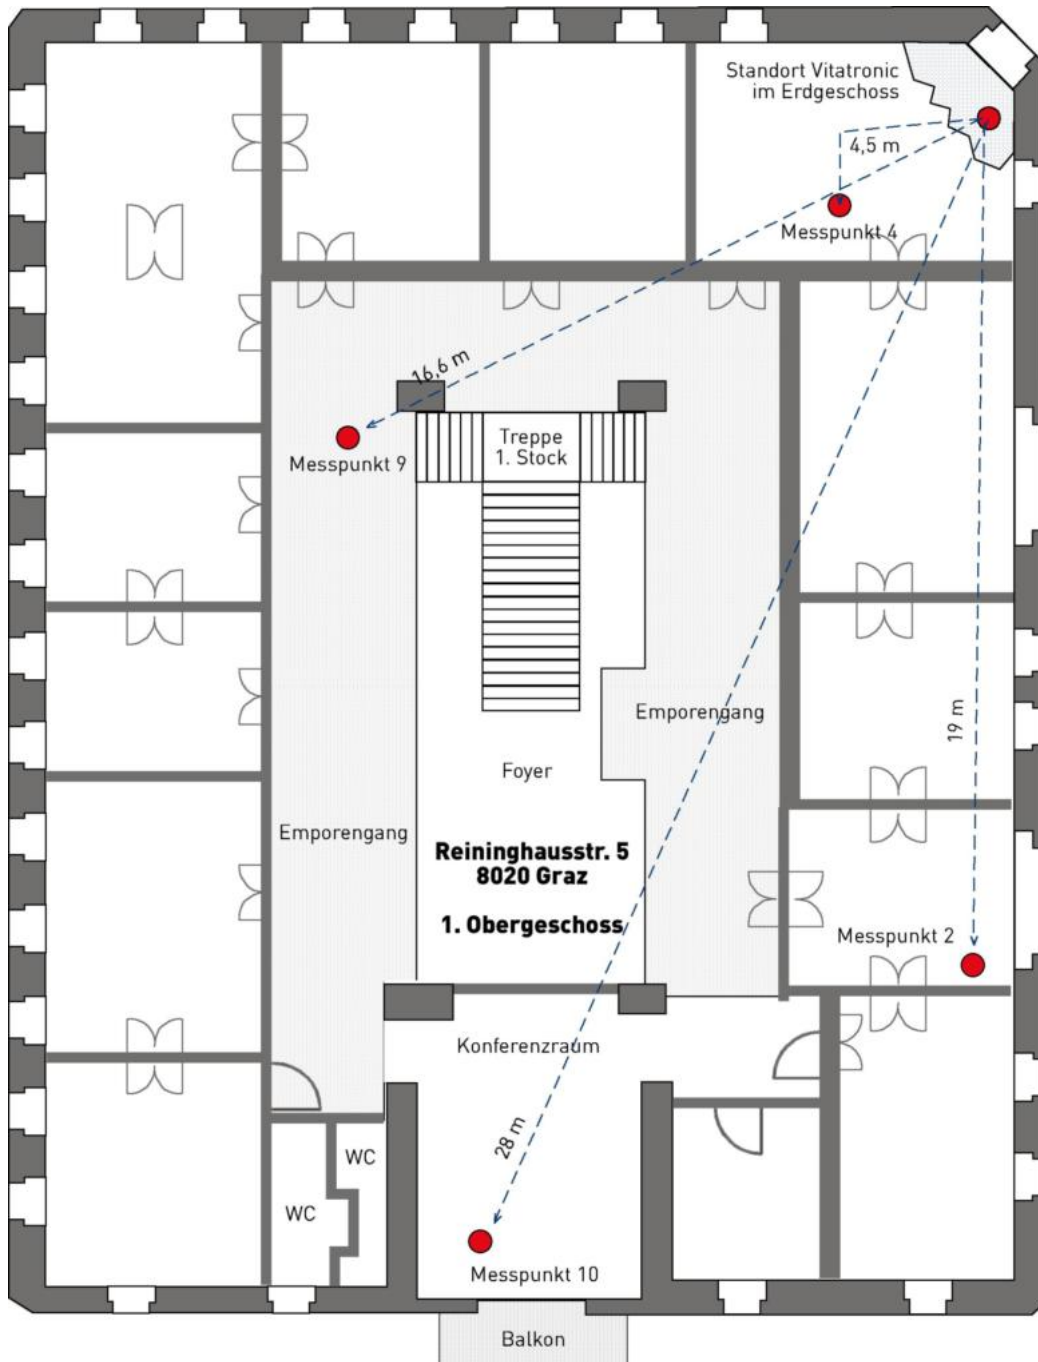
Obergeschoß des Gebäudes mit Messpunkten (Grundriss)
